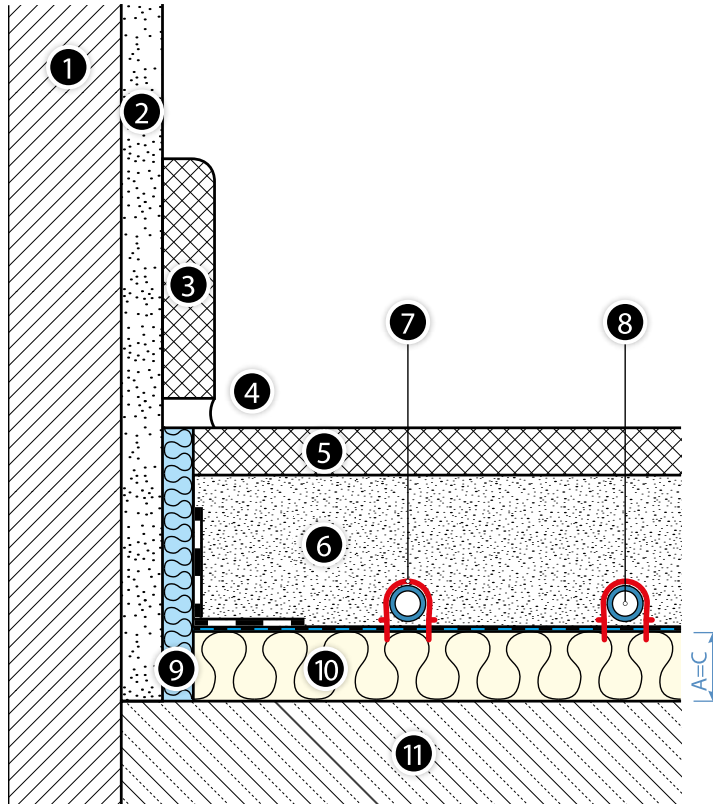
Гріюча системна плита KAN-therm Tacker з додатковою ізоляцією на перекритті над неопалюваним внутрішнім приміщенням, а також перекриттям, контактуючим із зовнішнім повітрям.
